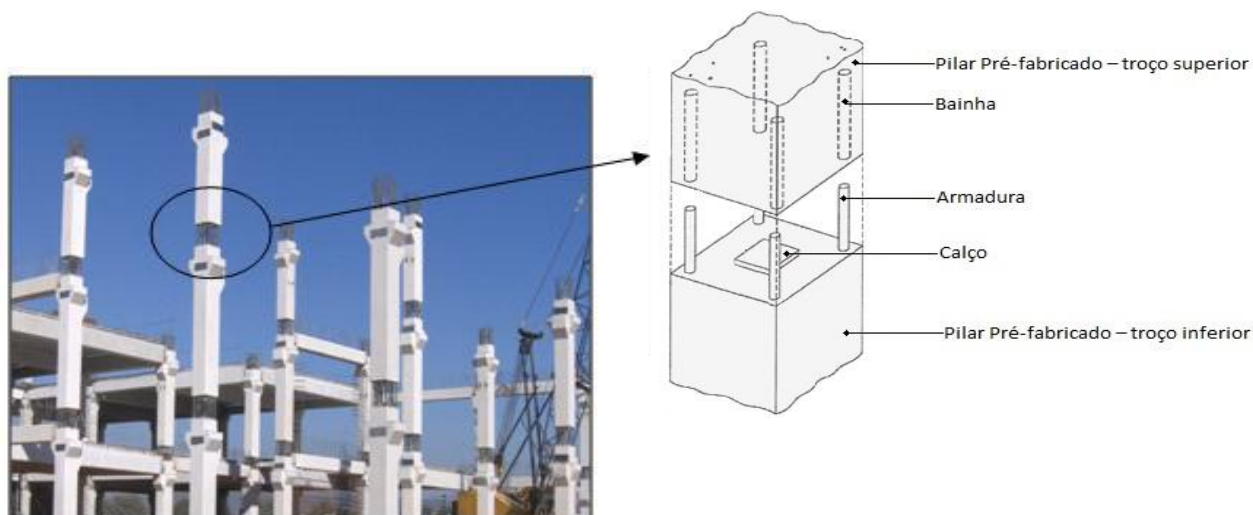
Ligação Pilar – Pilar por emendas [49]
